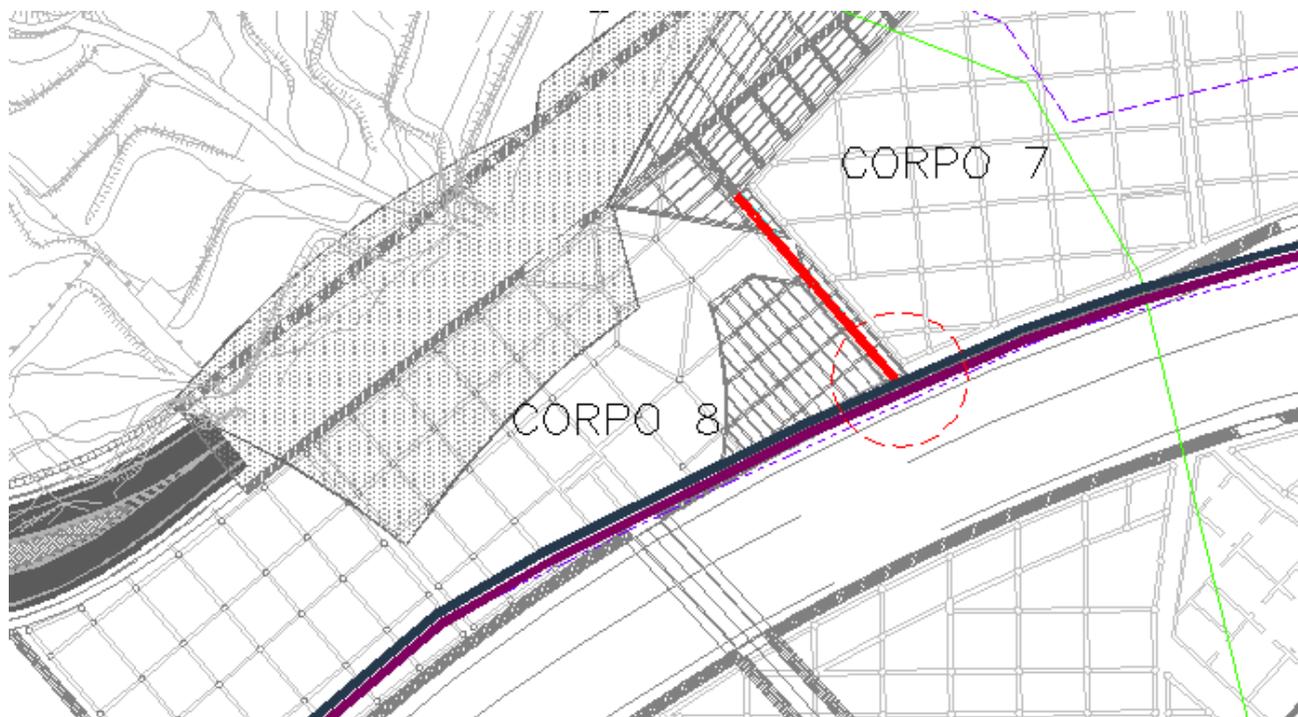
Stralcio planimetrico con l'individuazione delle interferenze
